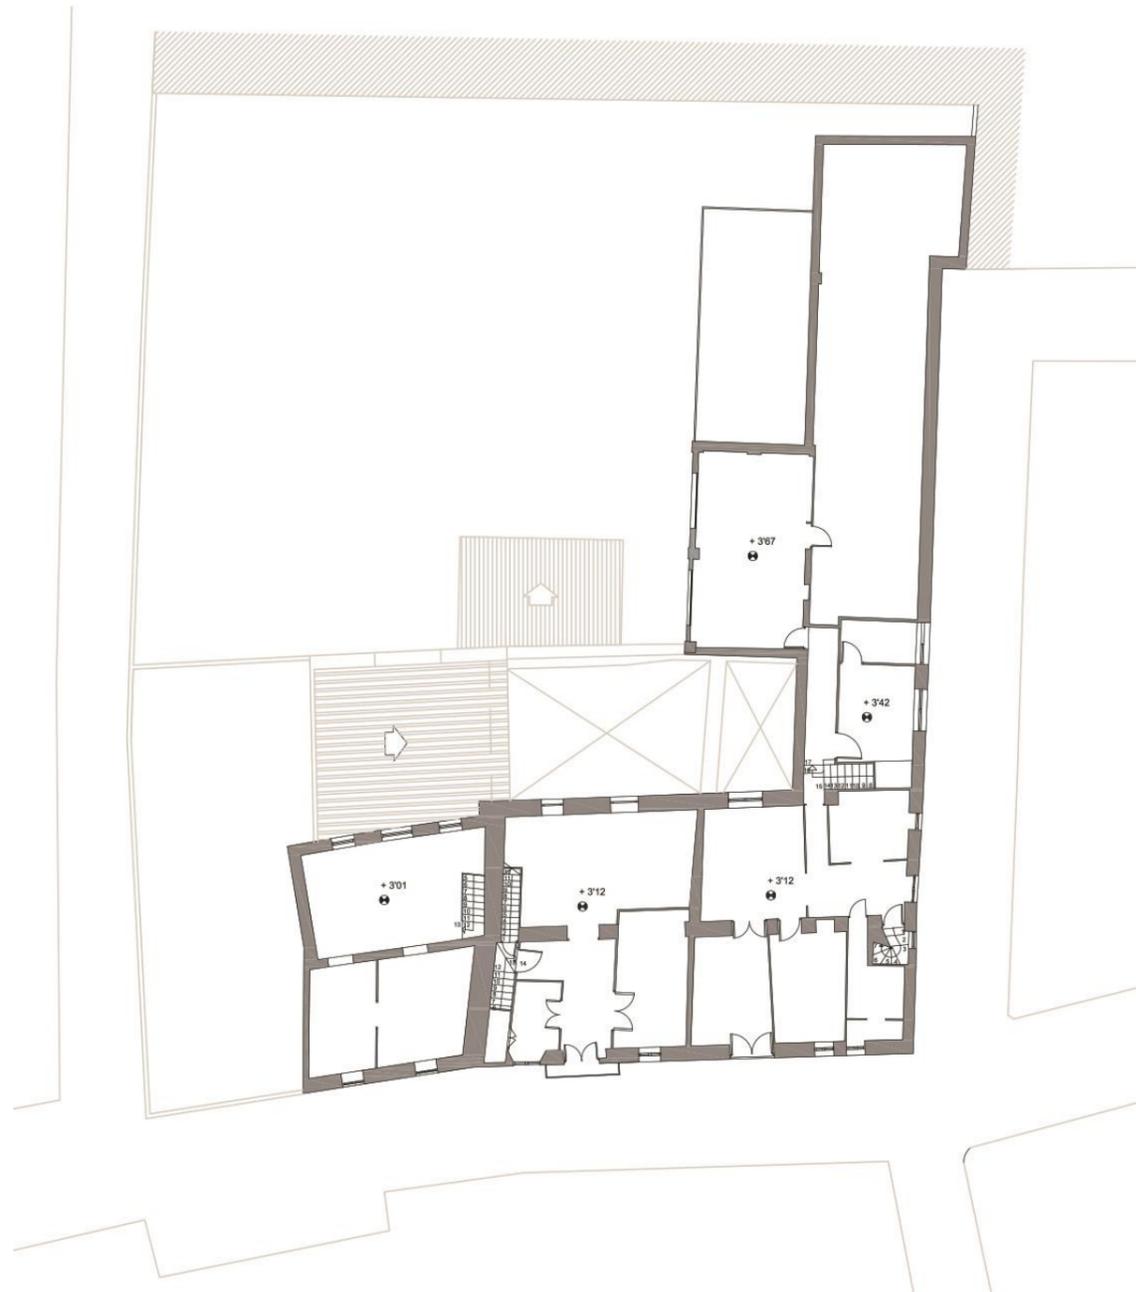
Puesta a escala planta primera general Fuente: Propia
